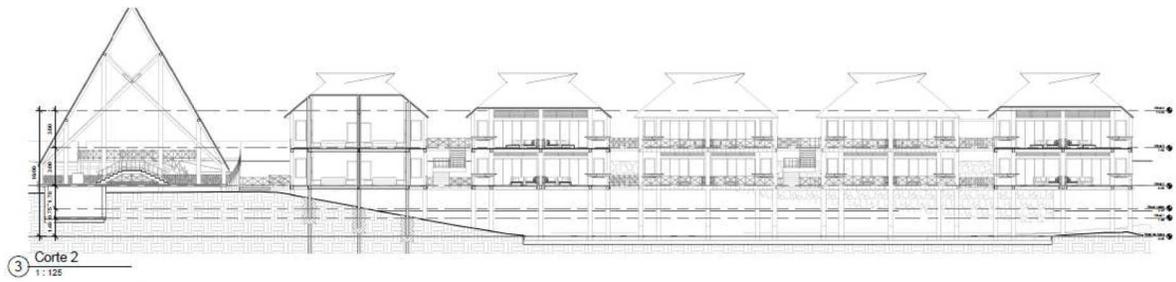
Detalles constructivos de las secciones de descanso para contemplación (cabañas rústicas), parte del centro ecoturístico.
